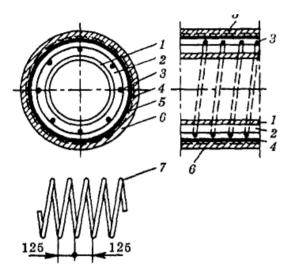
Конструкция монолитной армоненобетонной изоляционной оболочки
